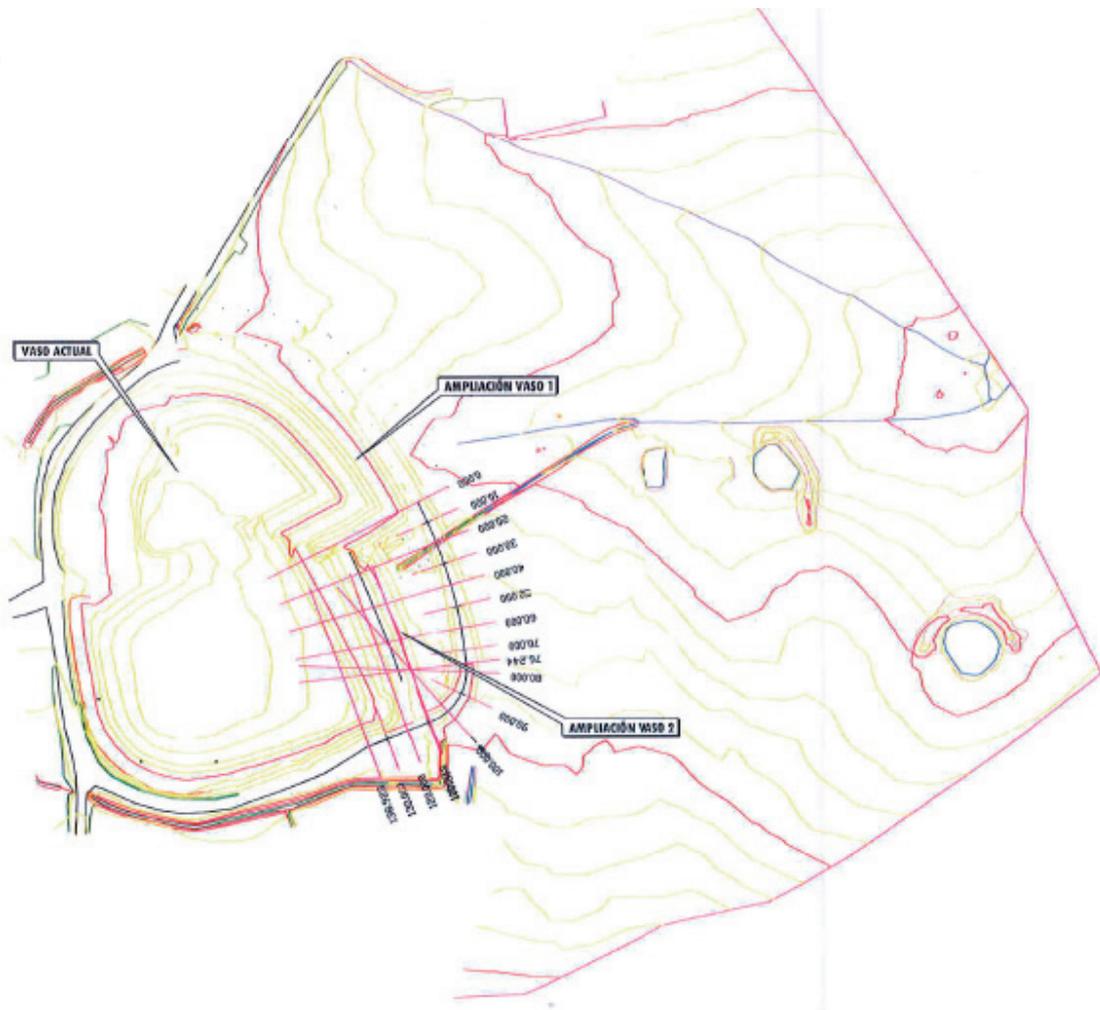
Plano en planta de la instalación. Zona de vasos de vertido.
